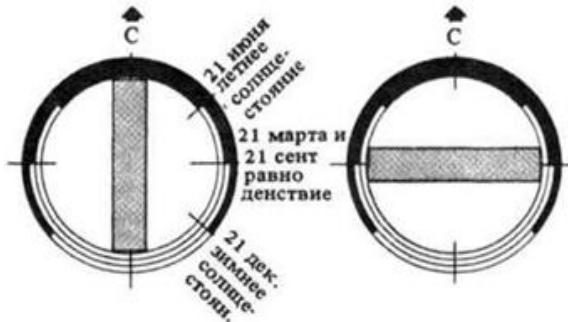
Меридиональная ориентация здания: инсоляция обоих продольных фасадов
